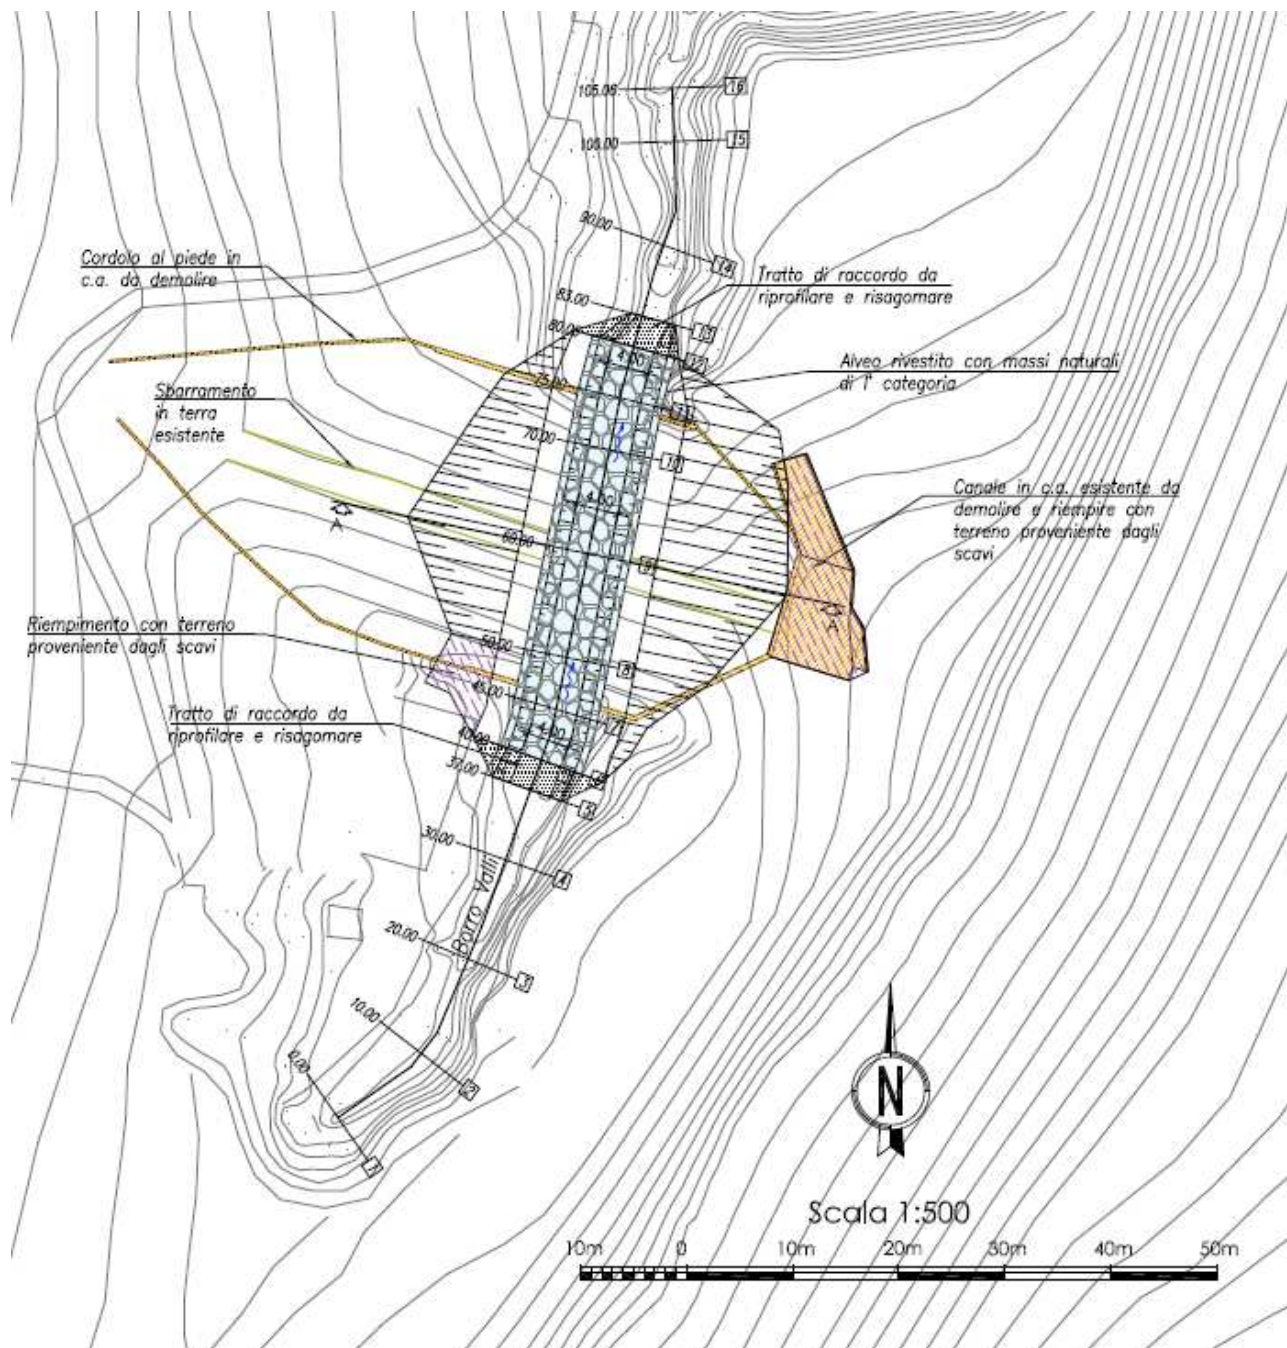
Sbarramento ST01 Valli – Planimetria progetto di demolizione
